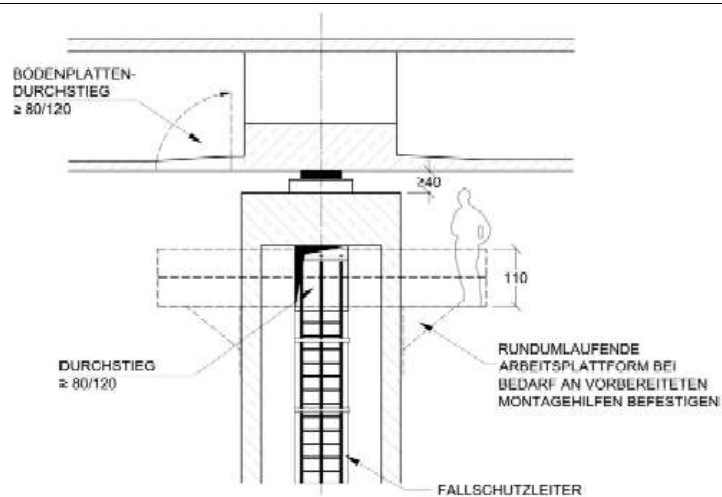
Ausführung von Durchstiegsöffnungen bei Pfeilern (alle Maße in [cm])
